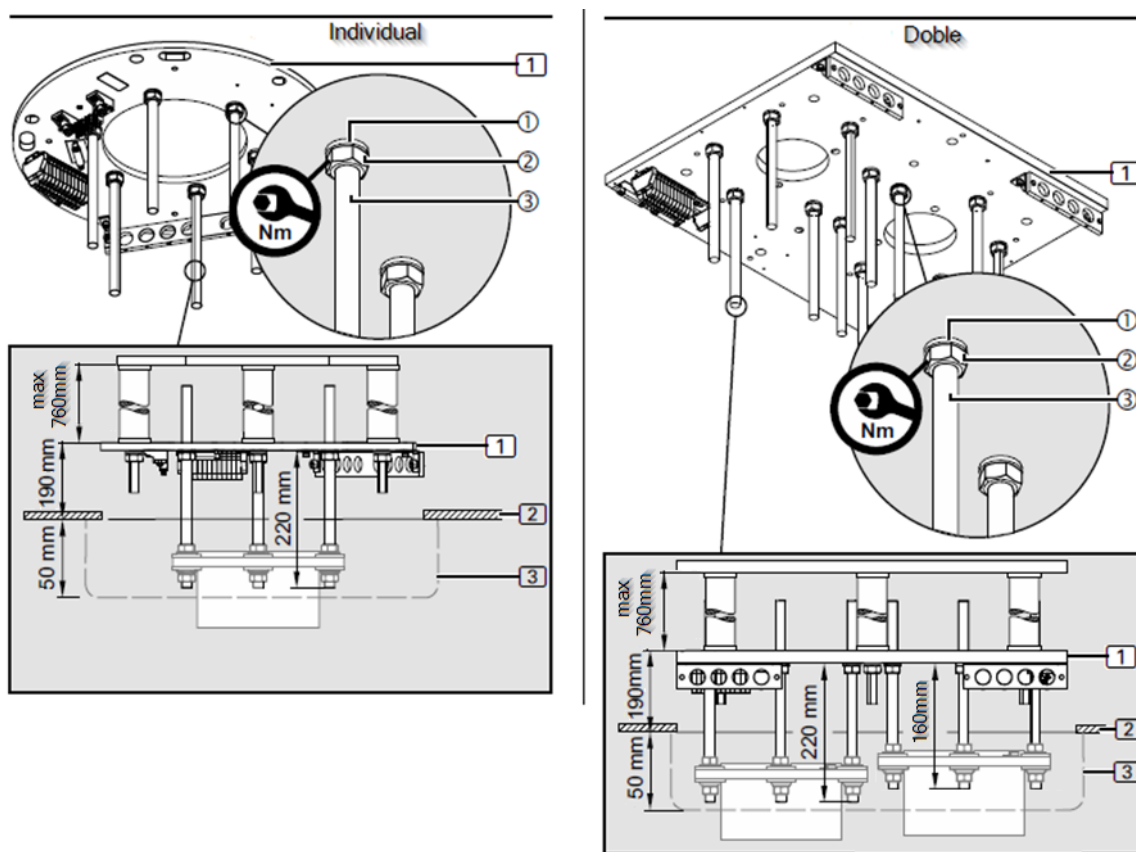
Montaje de placa de interfaz sobre estructura para falso techo bajo
